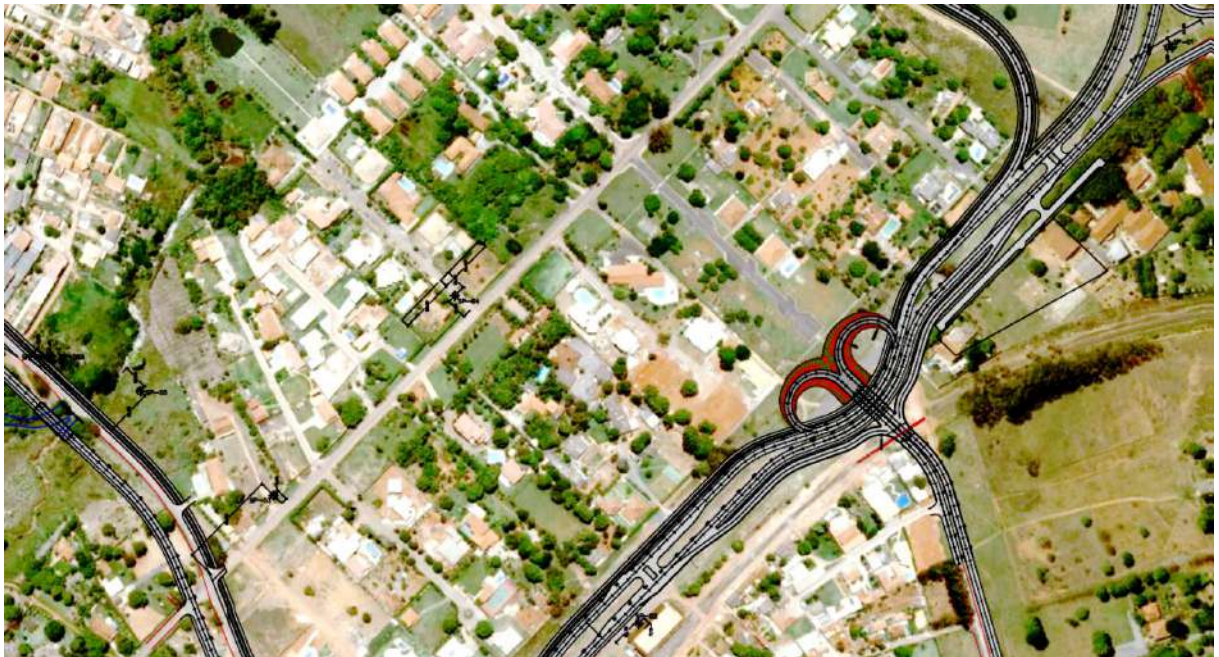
Vista Geral do Local das Sondagens Drenagem Pluvial na Ligação NB-Guará
